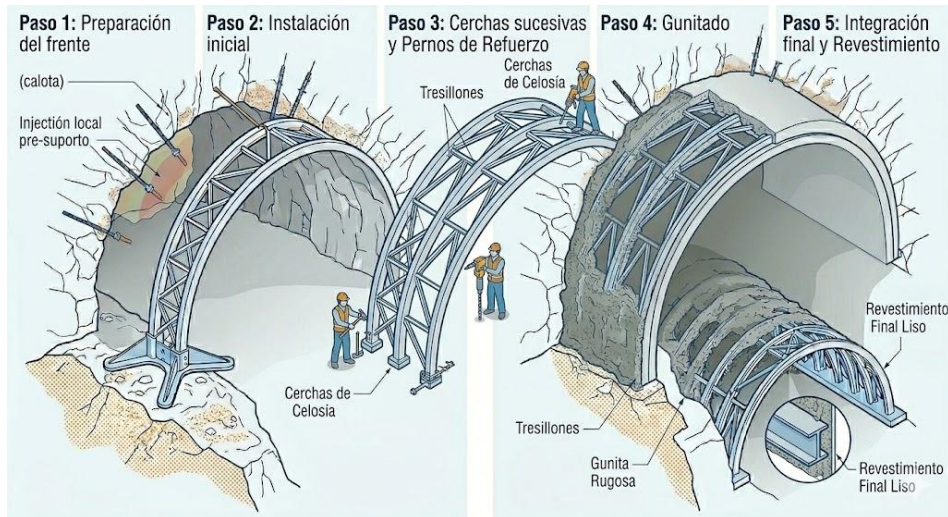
Proceso constructivo de las cerchas. Fuente: Elaboración propia
